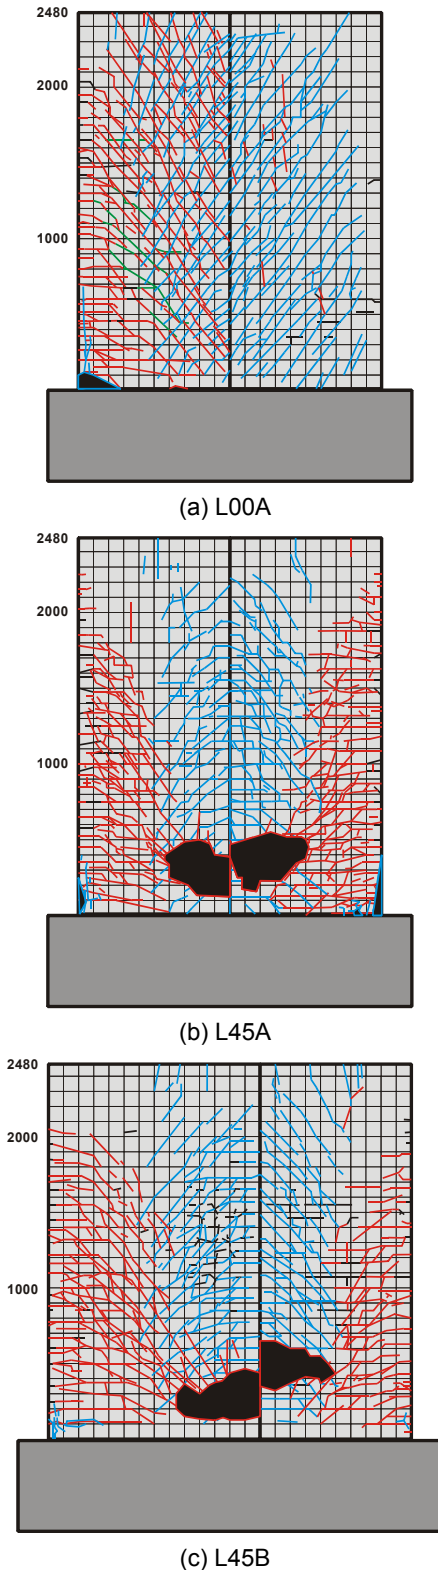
正側で耐力が急激に低下した時のひび割れ状況
